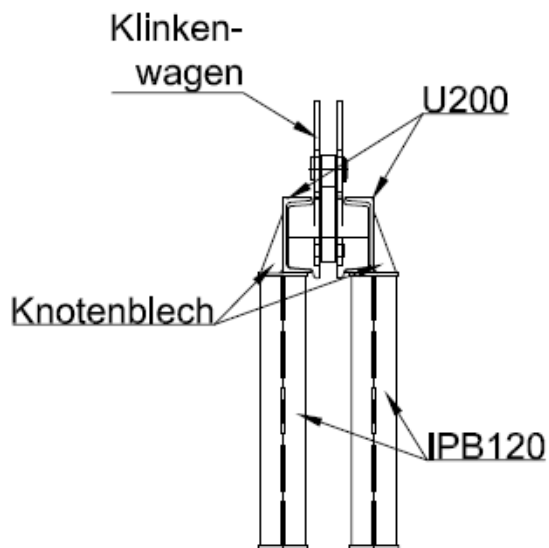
BG 7, 8 und 9; Position 1, Seitenansicht
